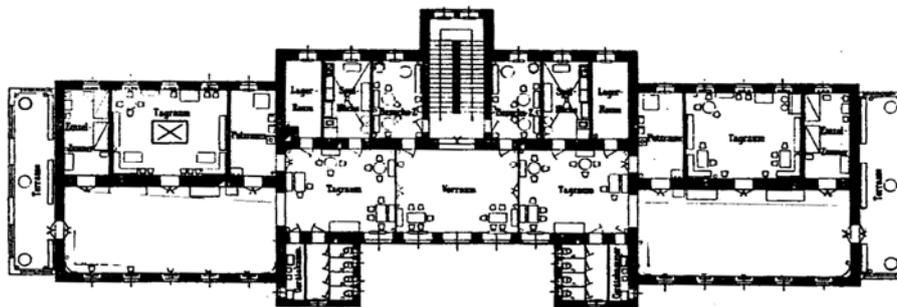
GRUNDRISS EINES PAVILLONS FÜR RUHIGE PATIENTEN IN STEINHOF
